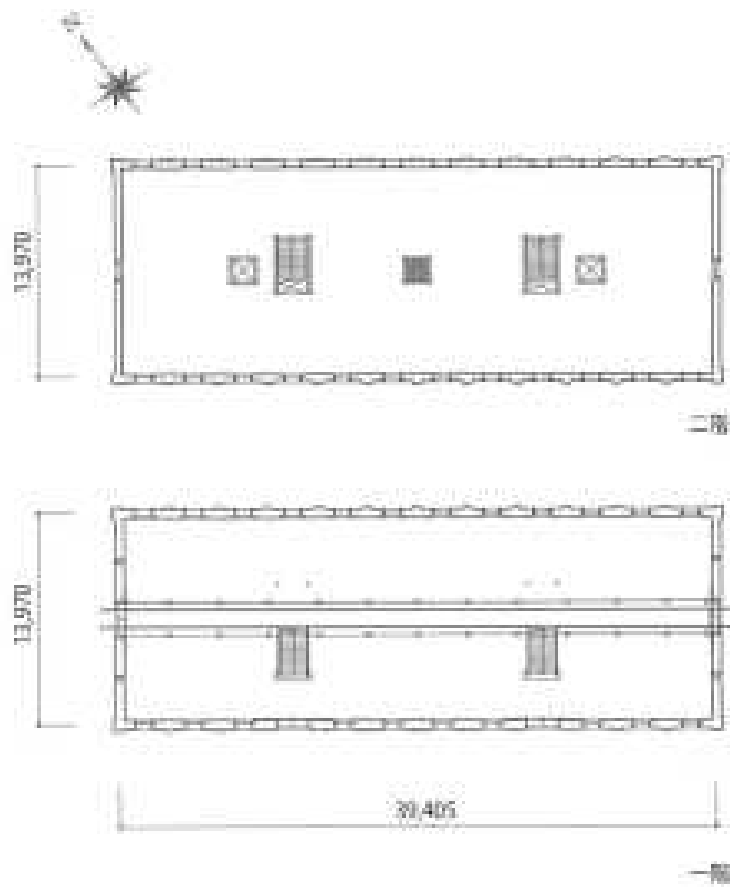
需品庫三棟（6号～8号棟） 平面図
